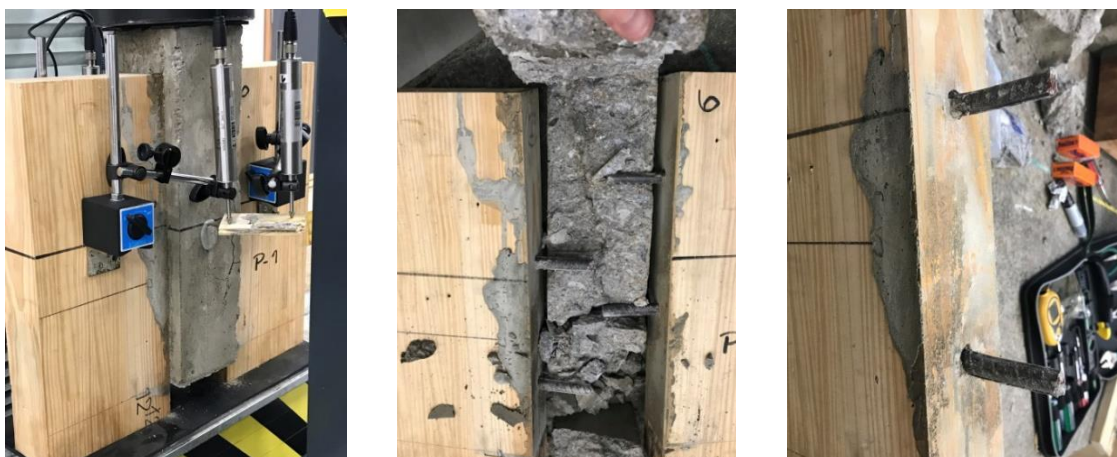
Rotura de la probeta de pino P1: a) fisura en el hormigón, b) flexión en el conector, y c) aplastamiento en la madera
